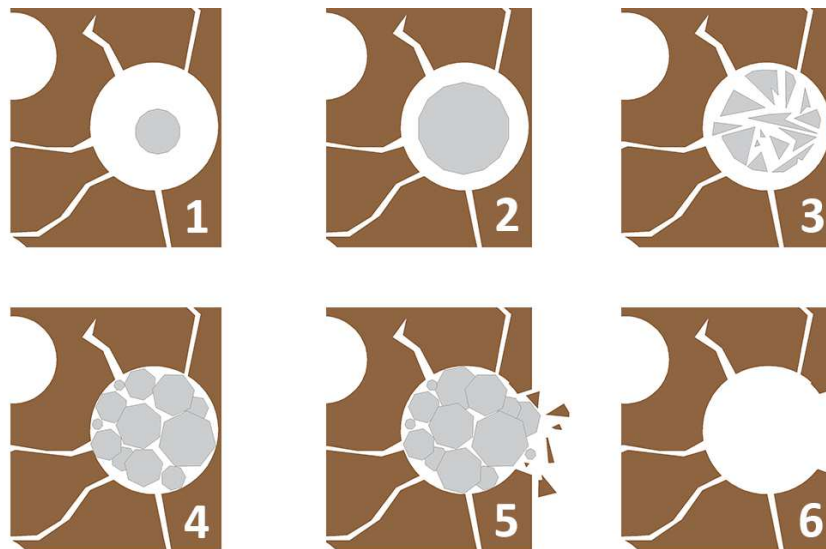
Detalle del deterioro del material del muro a causa de la humedad capilar.
